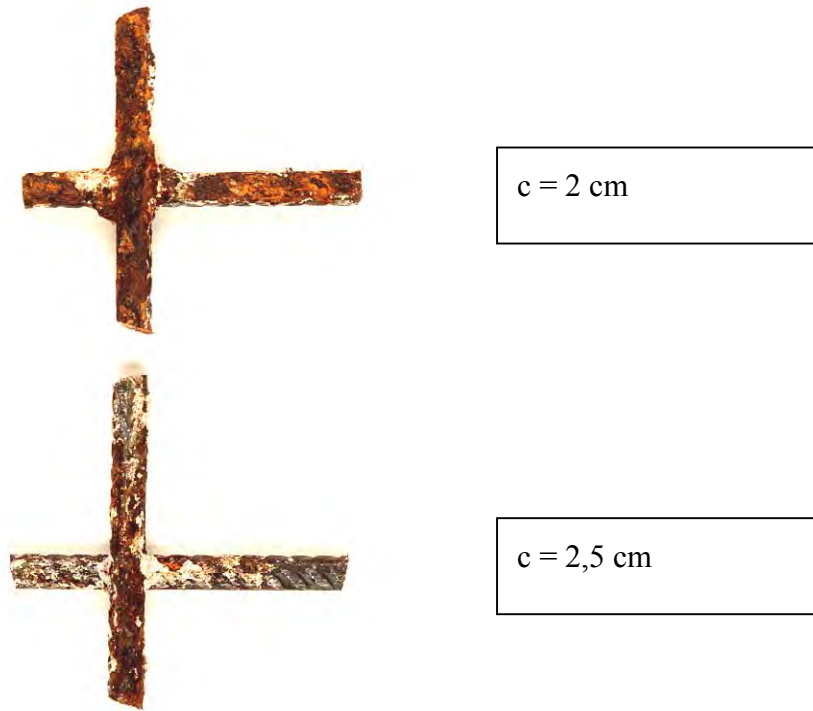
Ausgebaute Bewehrung aus Prüfkörper 1
